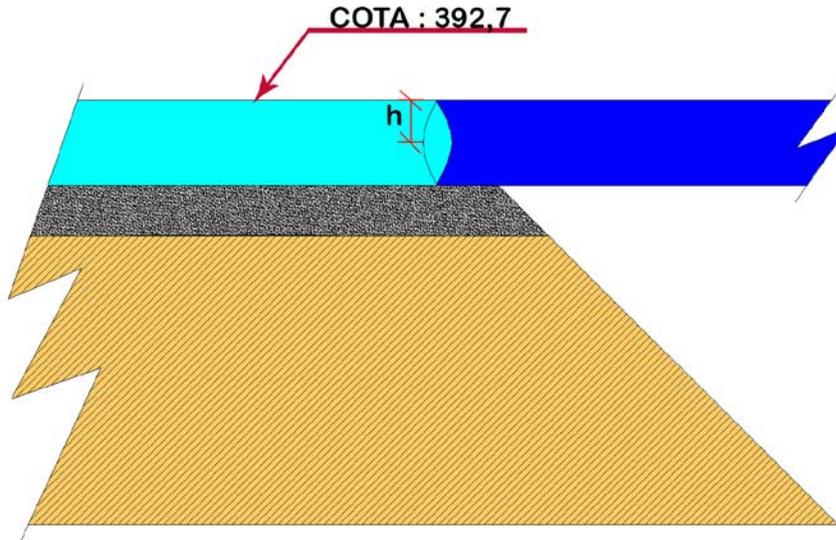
Esquema para cálculo caudal tubería y obra de captación.
